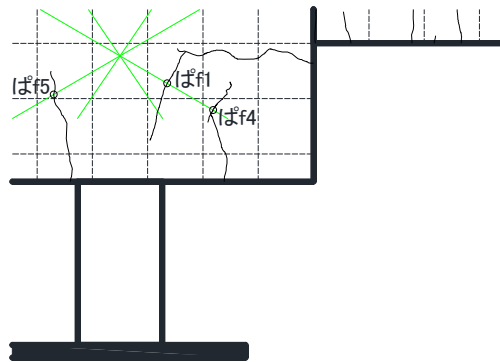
パイルキャップ側面ひび割れ幅測定位置 危険断面位置
